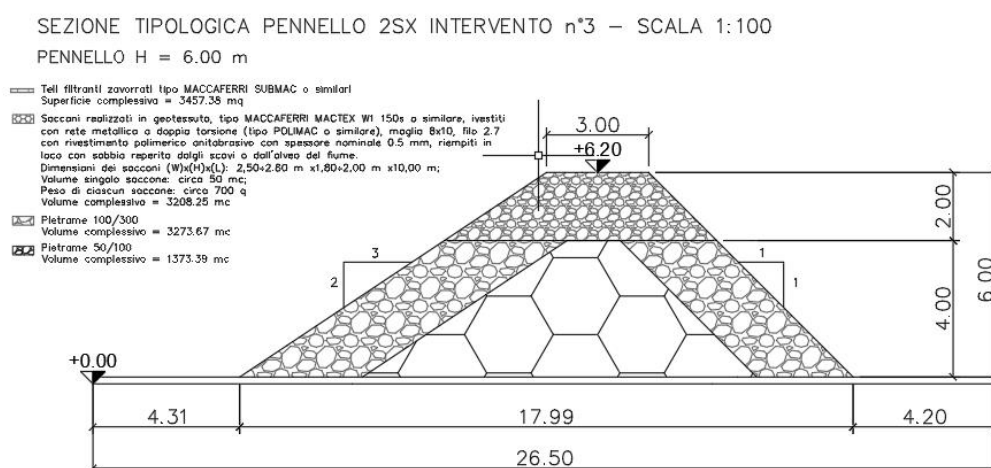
Sezione tipologica esemplificativa delle opere in progetto
